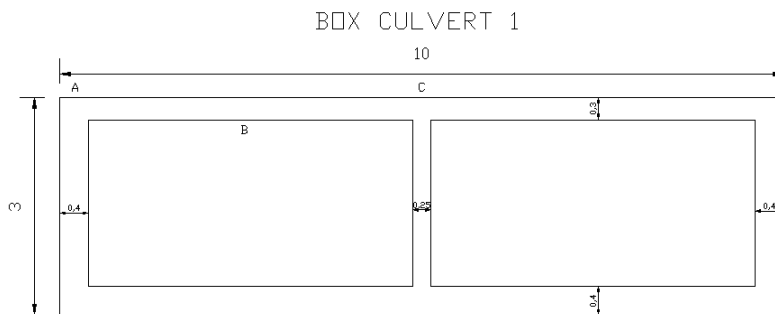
Corte del Box Culvert 1 acotado en metros.
